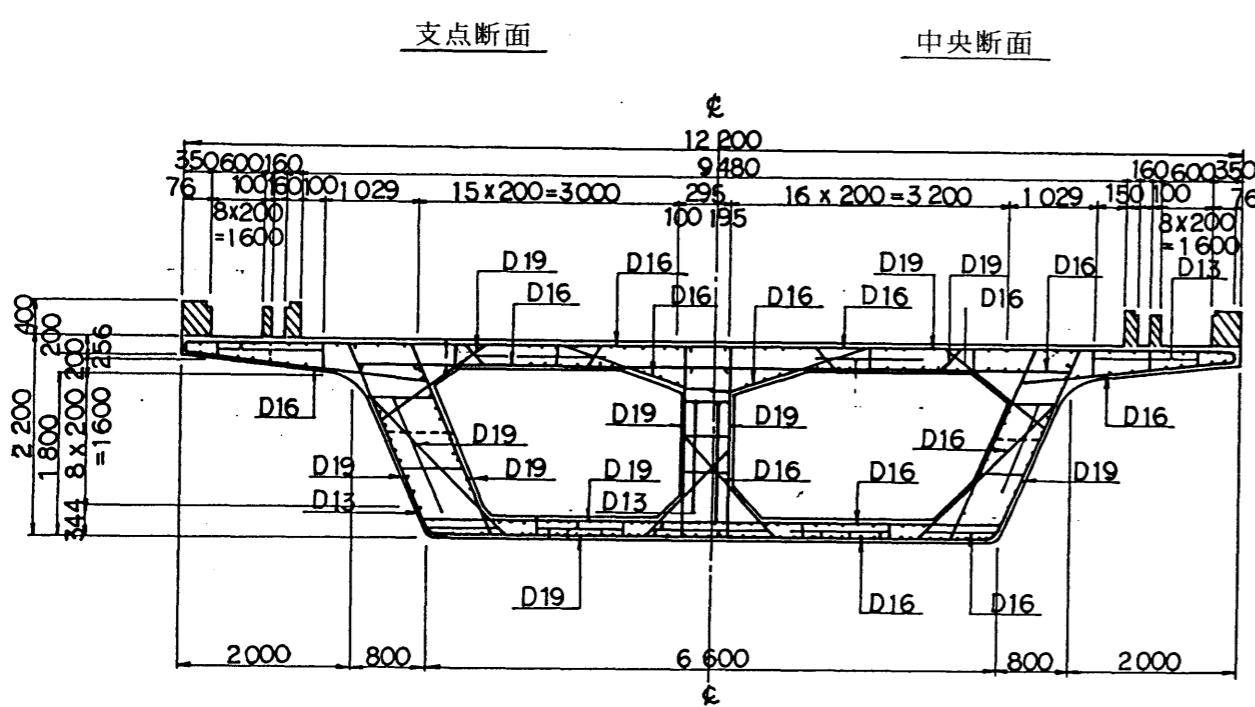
東北新幹線RC箱桁標準断面鉄筋配置図
